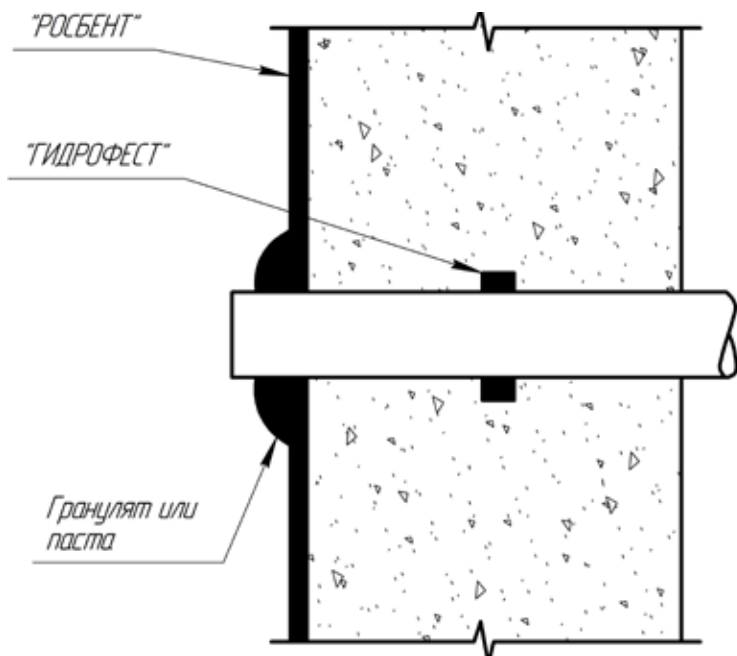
Гидроизоляция отдельной конструкции проходящей через стену
